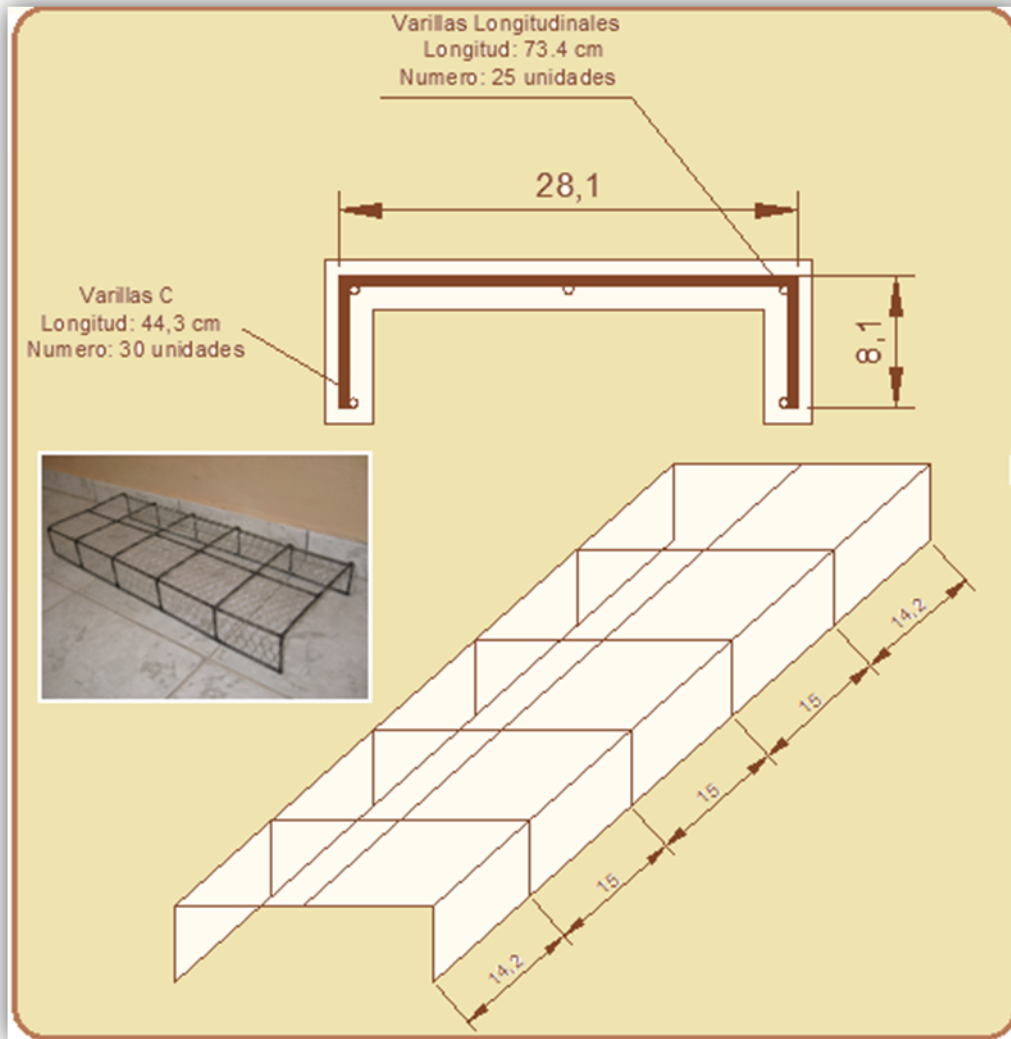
Dimensiones de la sección y armado de la estructura de acero
